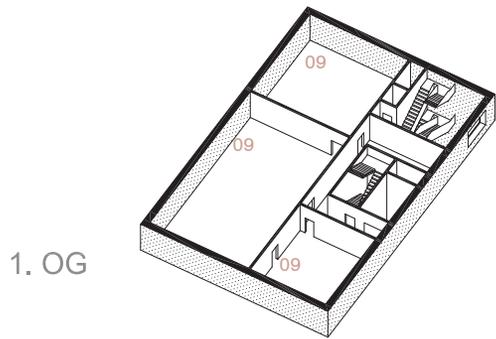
3D Darstellung, Grundrisse museum, Grundrisse museumsinterne Funktionen
